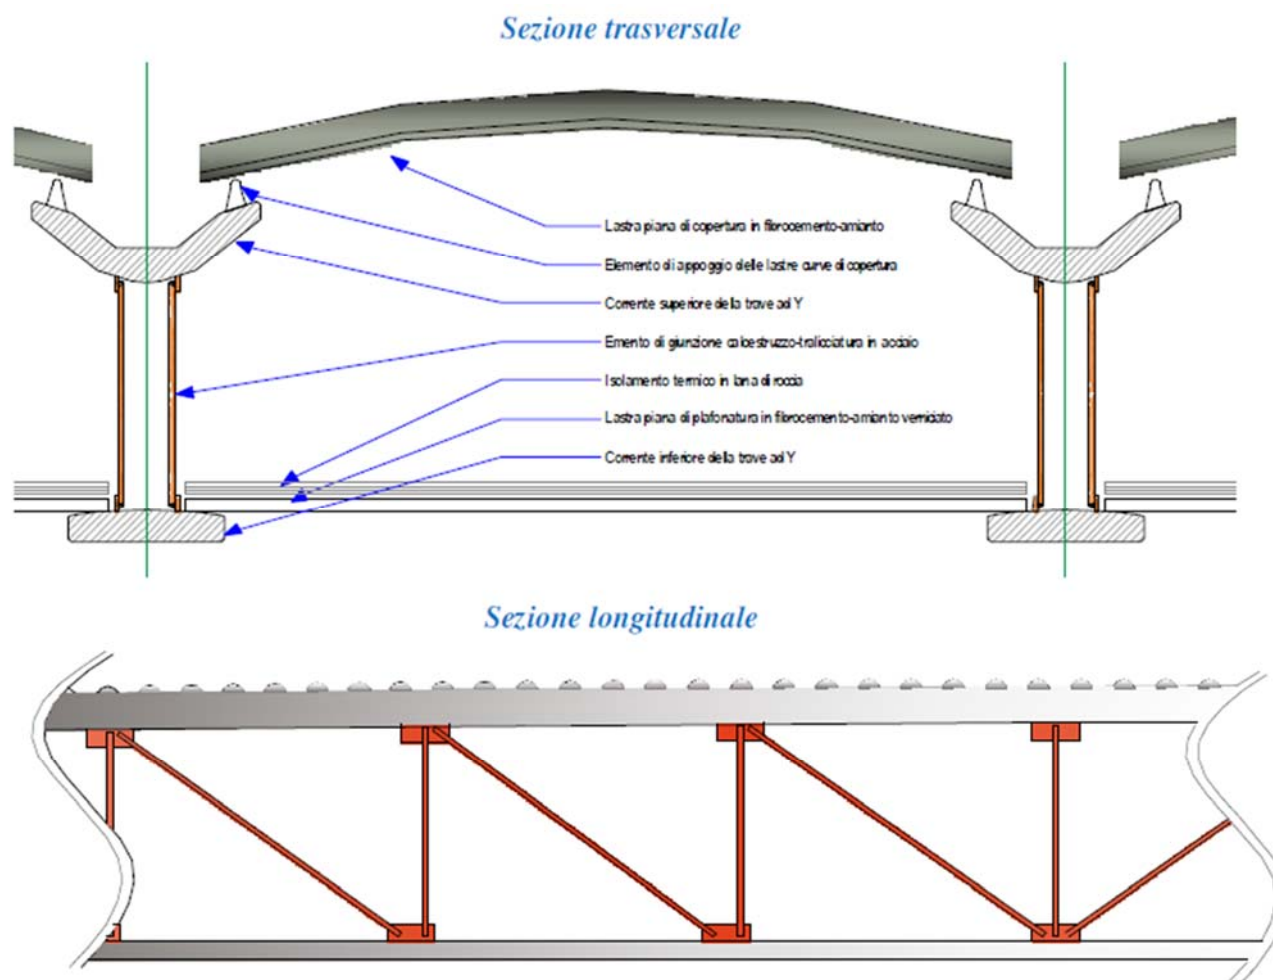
Particolari costruttivi delle travi ad Y tipo “P1 di Baraclit
